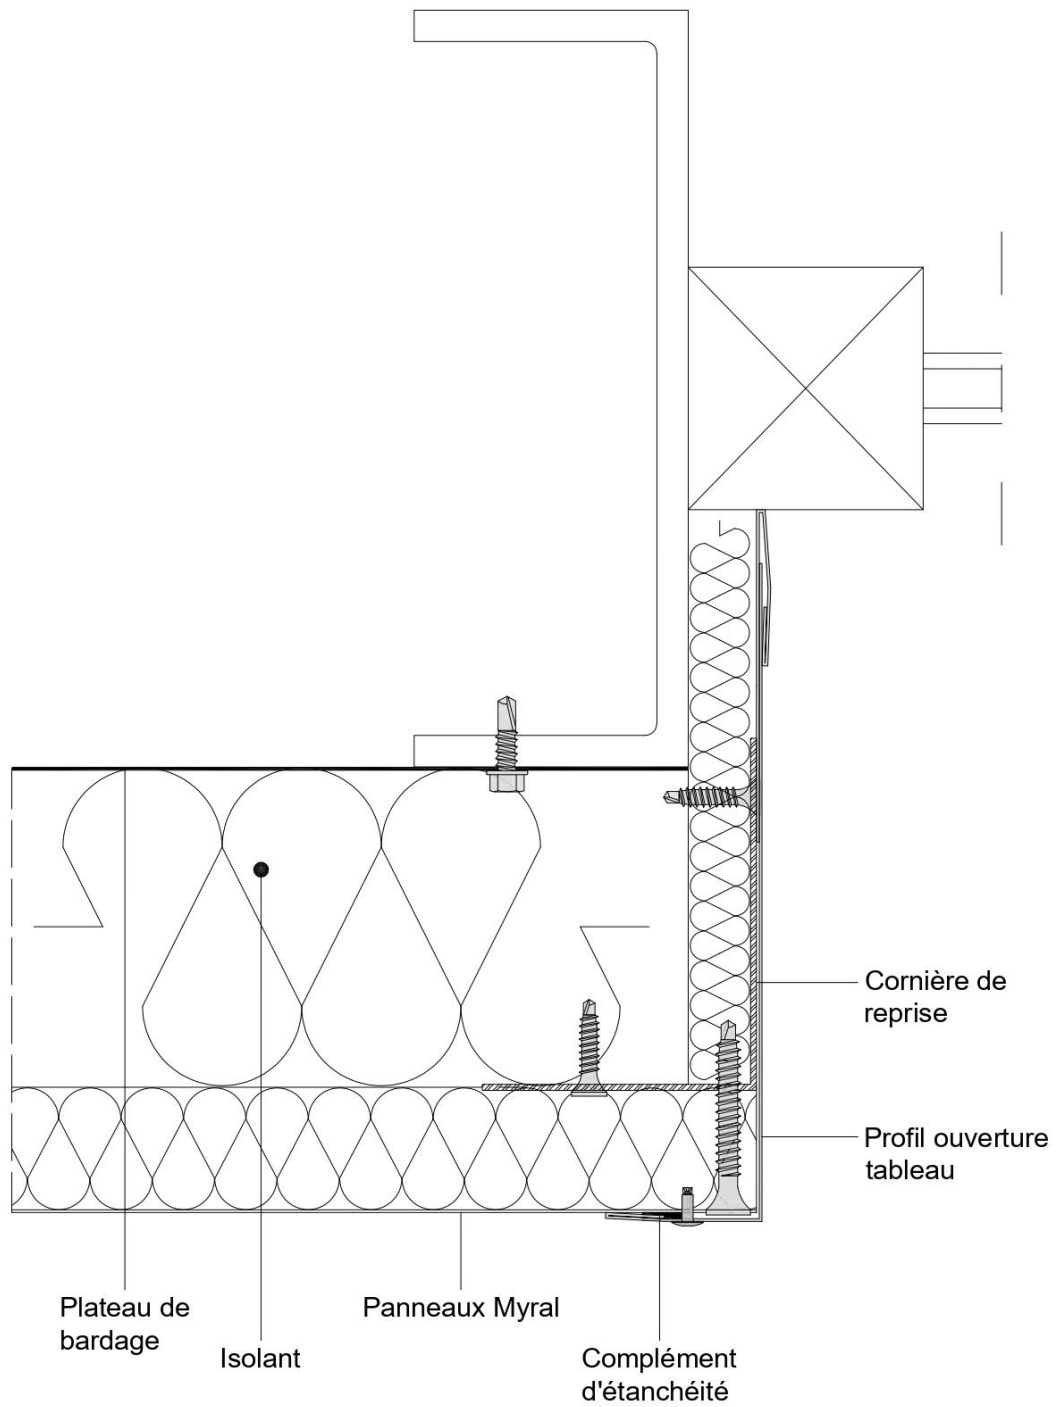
Habillage de baie – Tableau (coupe horizontale)
